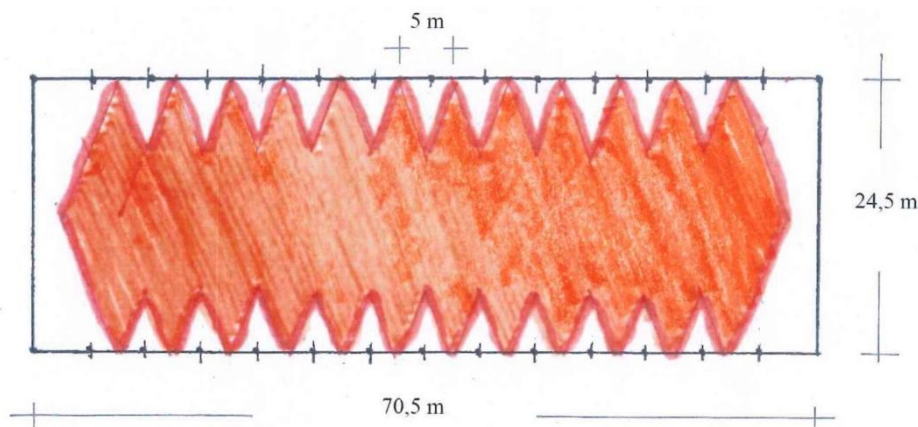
Diffusione in ambiente dell'aria immessa dalle bocchette, vista in pianta. Scala 1:500
